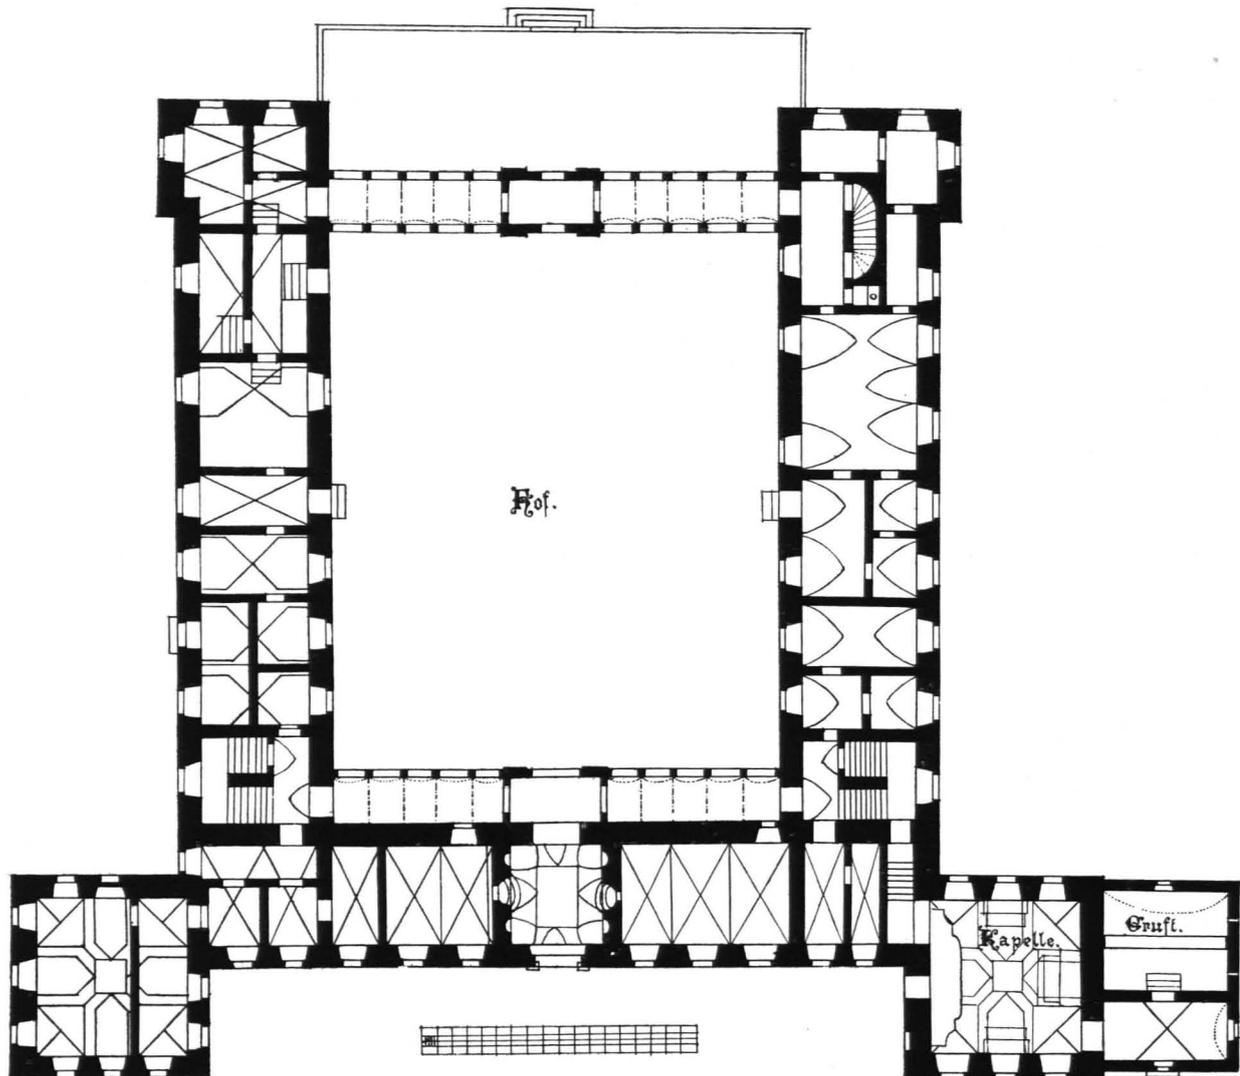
Schloß Schwarzenau, Grundriß im Erdgeschoße, 1 : 500 (S. 189)
